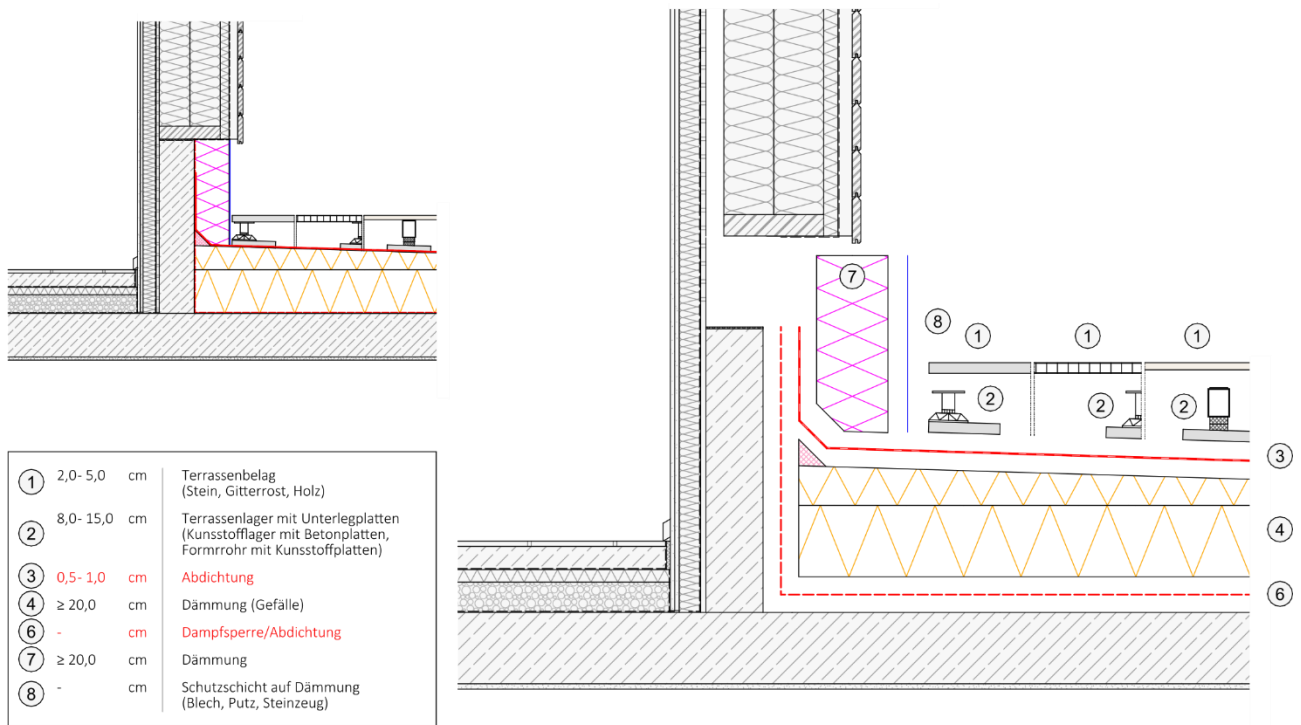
Detailausbildung – Holzrahmenbau / Holzmassivbau auf Betonsockel
